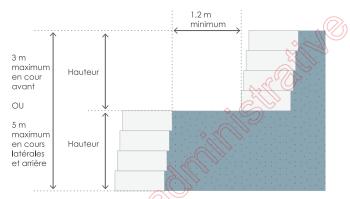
Coupe de mur de souténement aménagé en paliers successifs
